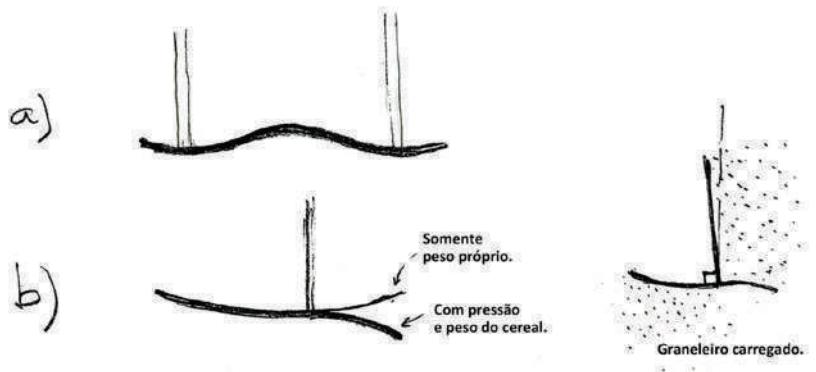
Vista a) e b) da deformação da laje de base do oitão quando o graneleiro está carregado, ou vazio. (*-5).
